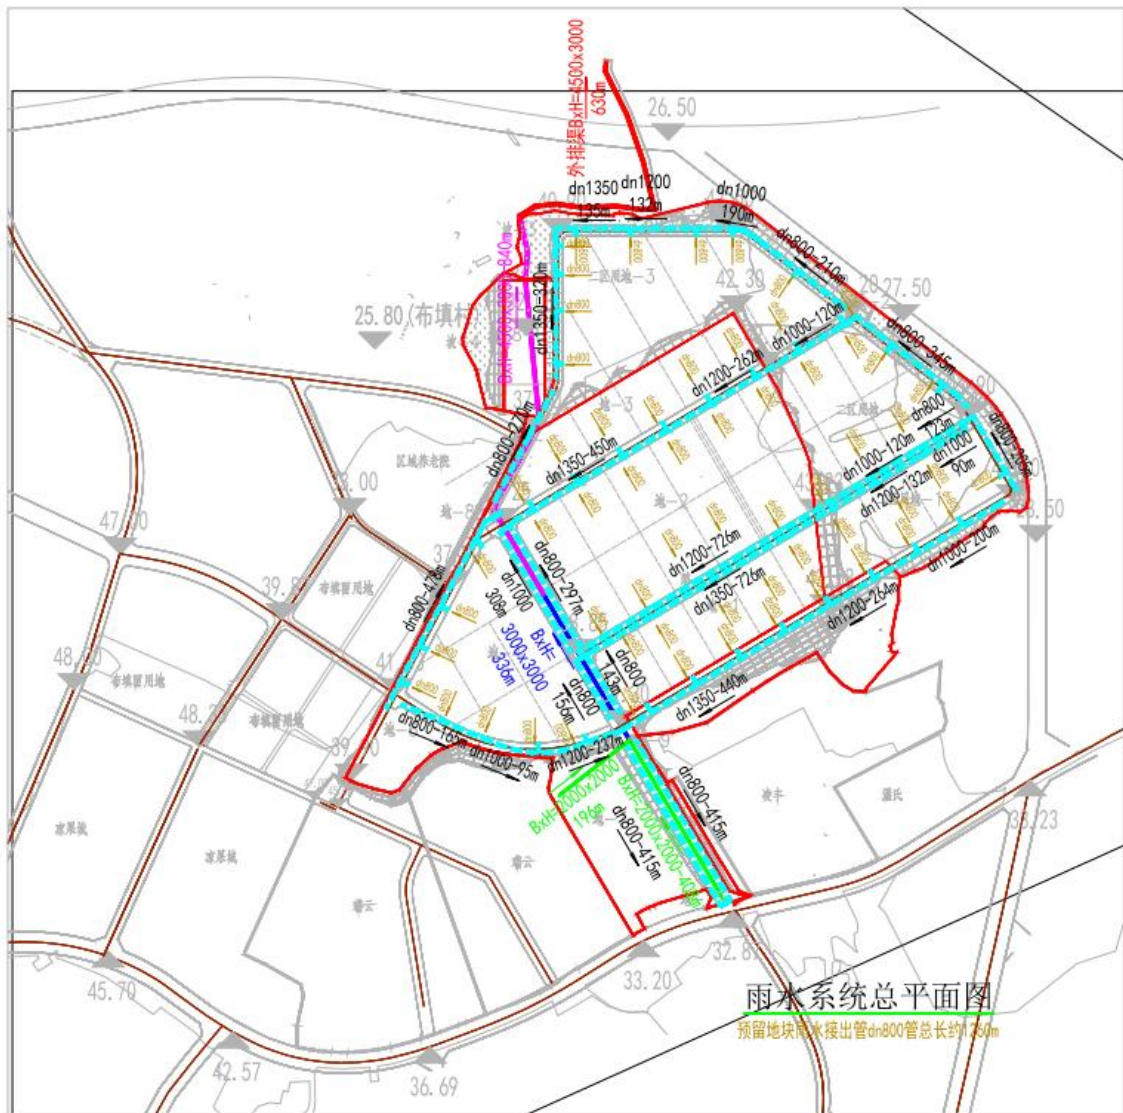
1 雨水系统总平面图（总平面为主管网的路线，估算工程量表包含预留给厂房接入“预留管”长度的汇总工程量）
